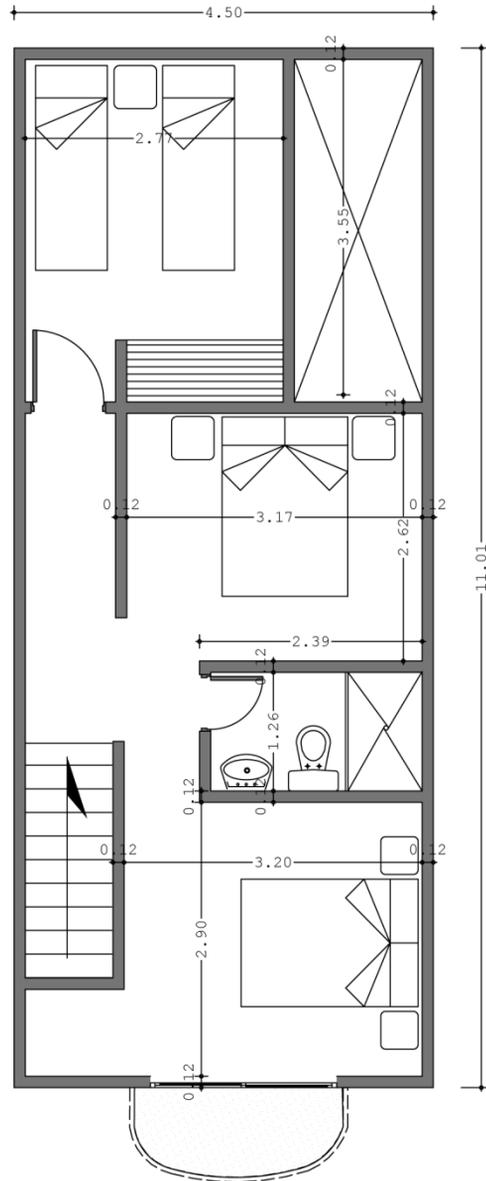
Planta arquitectónica segundo piso casa ampliada
